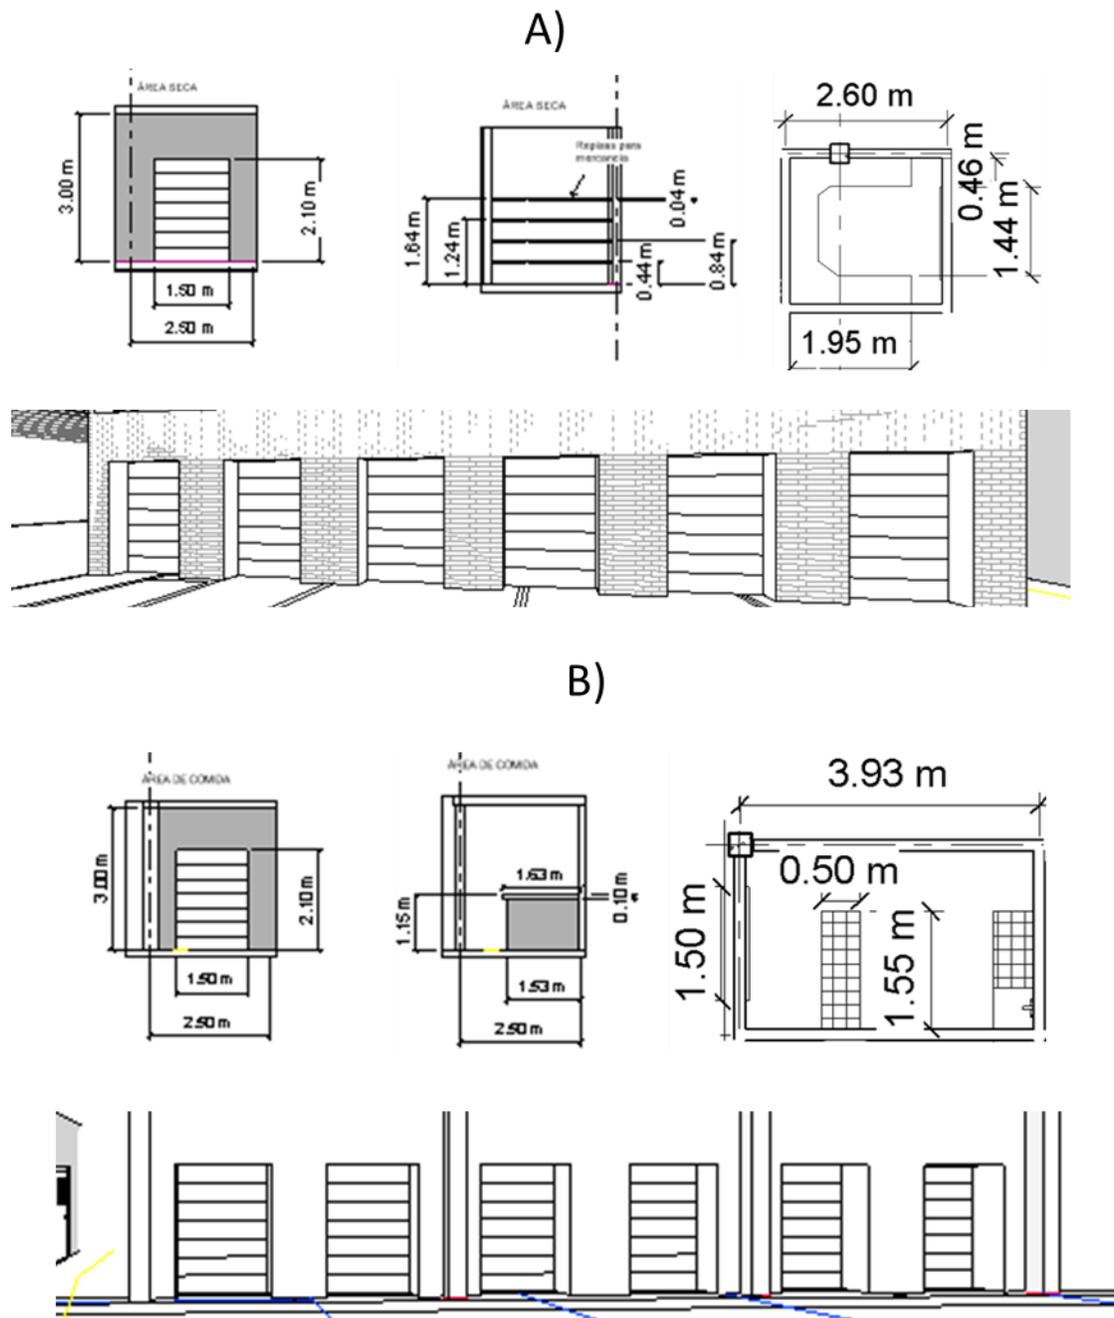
Distribución arquitectónica en planta. Fuente: Autor.
